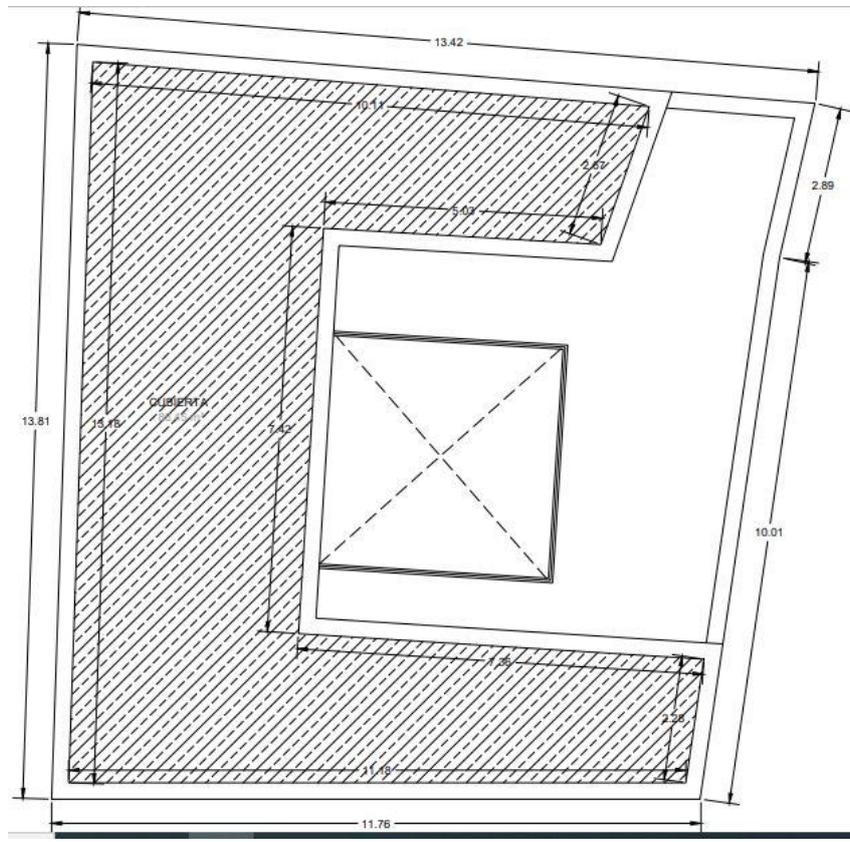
Plano planta cubierta del edificio (Elaboración propia)
